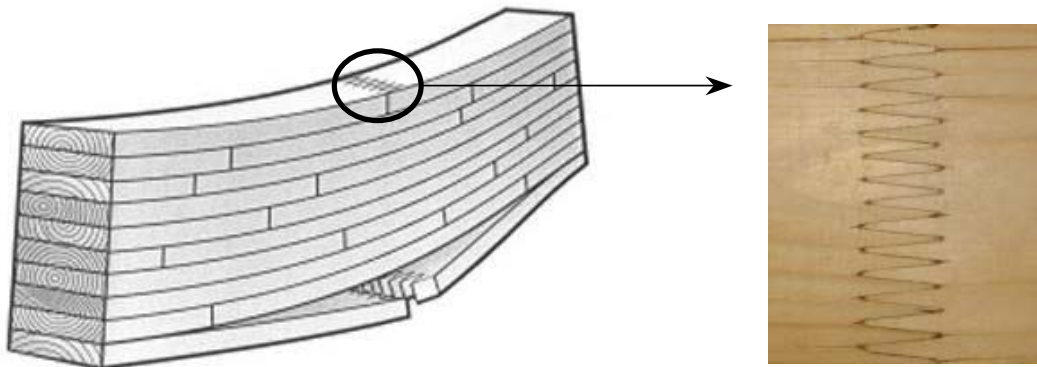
Joint abouté à entures multiples d'une poutre lamellée collée [132].
